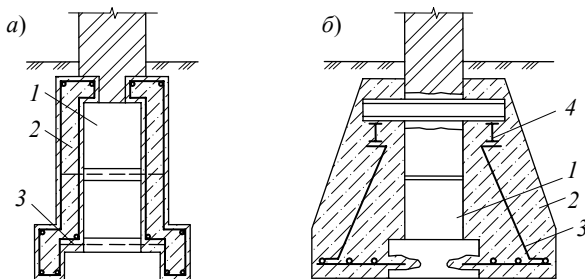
Варианты усиления сборных ленточных фундаментов с помощью:
